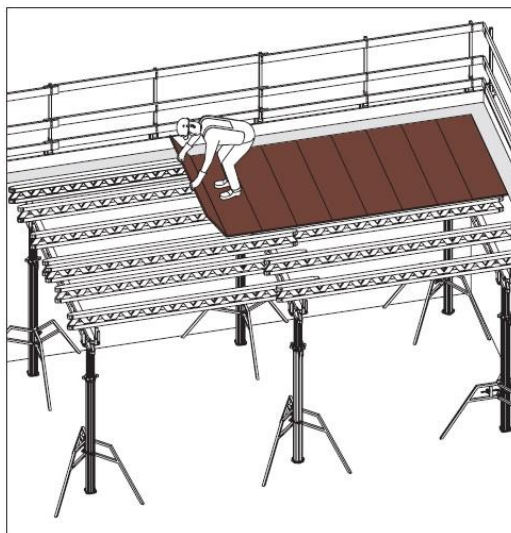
Монтаж палубы (элемента настила)
